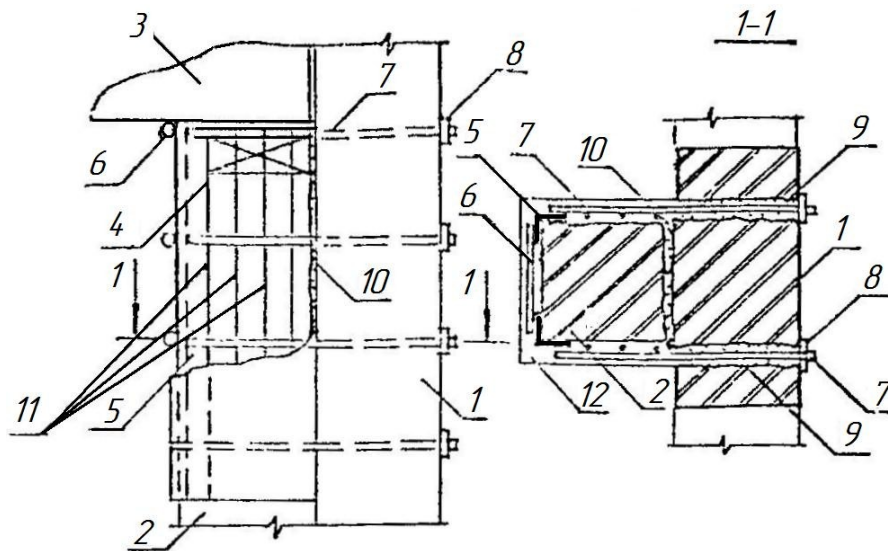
Посилення вузлів опирання балок і плит на цегляні стіни влаштуванням залізобетонних обойм:
